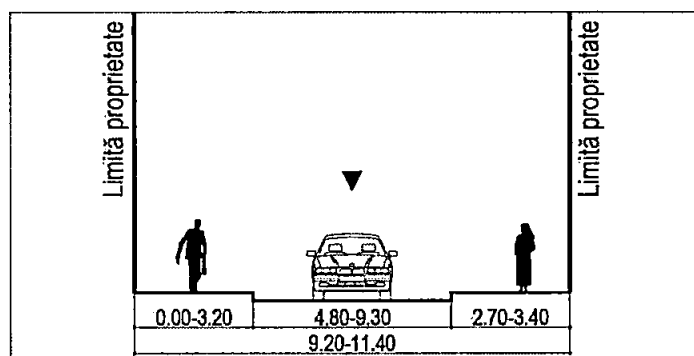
Profil stradal existent - stradă fără nume (tronson Bd. Al. Lăpușeanu – Al. Daliei). Sursa: autori.
